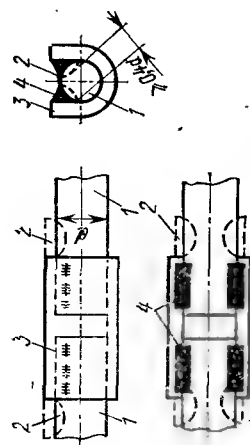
Соединение стержней при ванно-шовной сварке:
